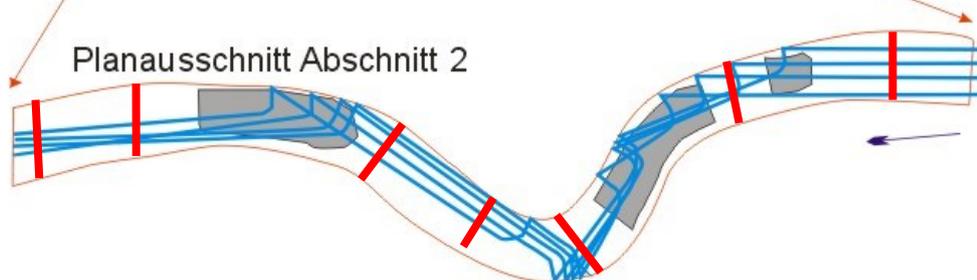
Lageplan der Laufverlegung am Schafflunder Mühlenstrom aus (NICOLAISEN 2007, ergänzt).
